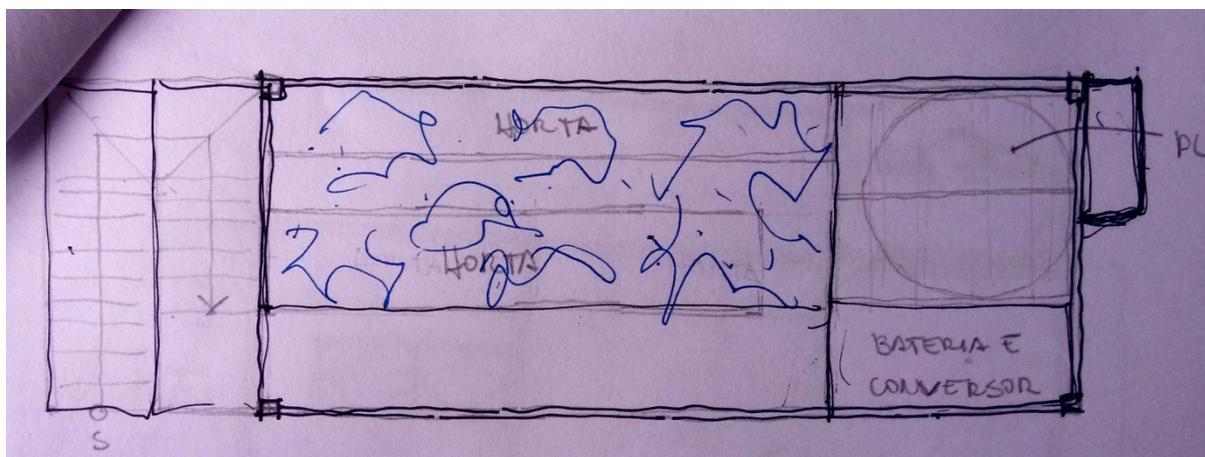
Croquis da planta de cobertura (EQUIPE 2)
